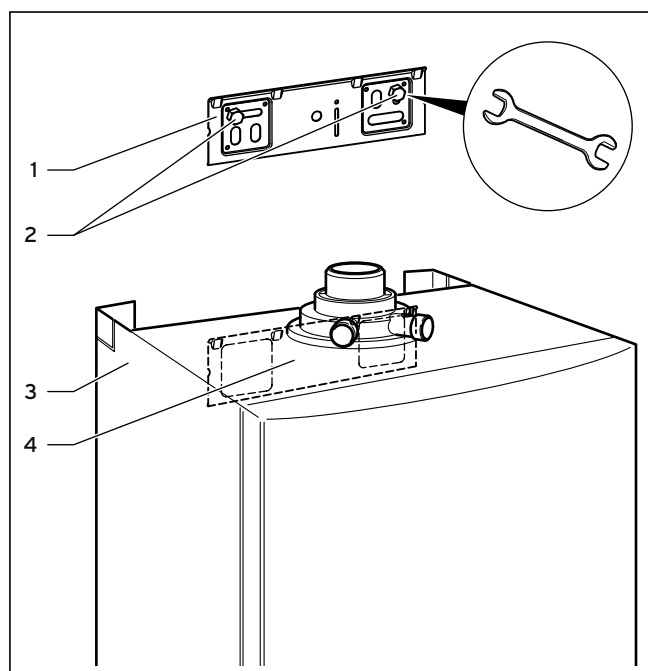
Pose de l'appareil de chauffage sur son support
